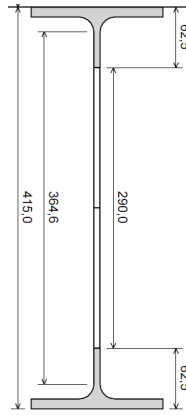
Sección neta de la viga Angelina en la Zona D
